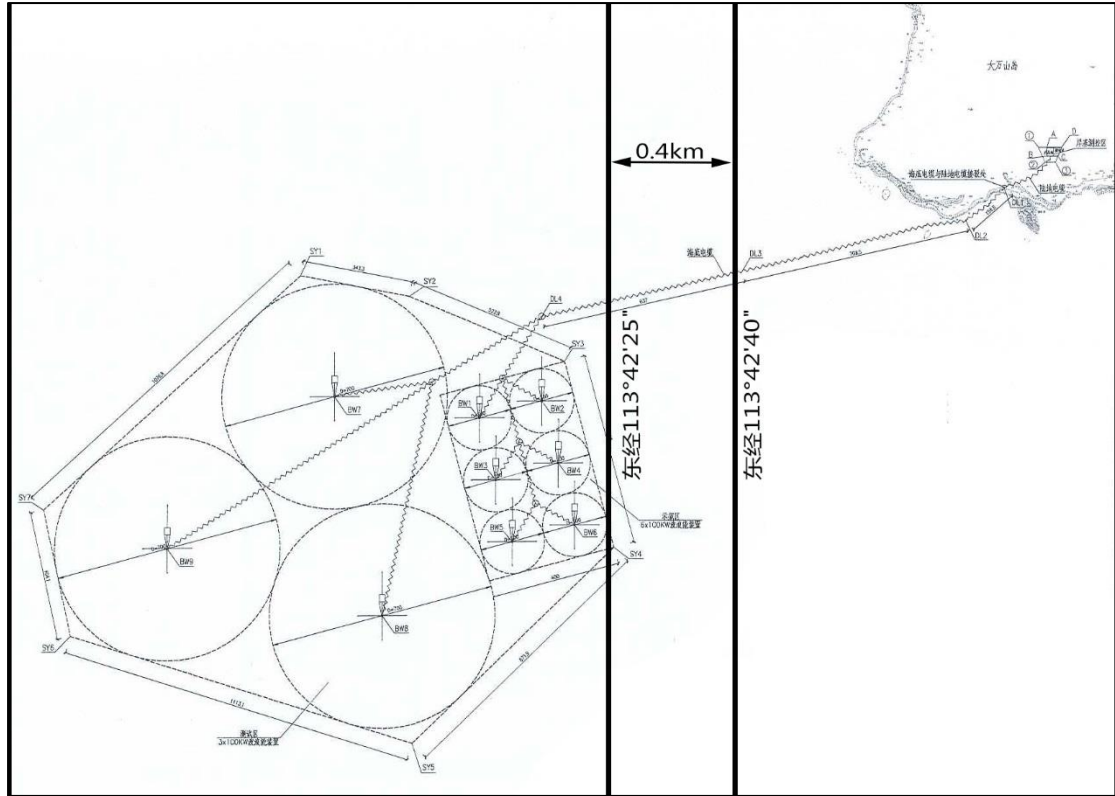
调整后工程总平面布置图及与部队要求关系图
